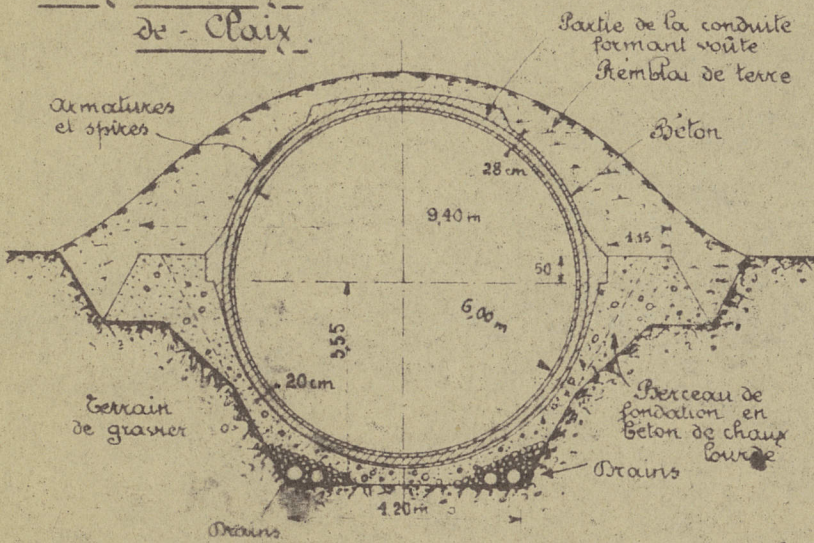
Conduite forcée en béton armé de pont-de-Chaix
